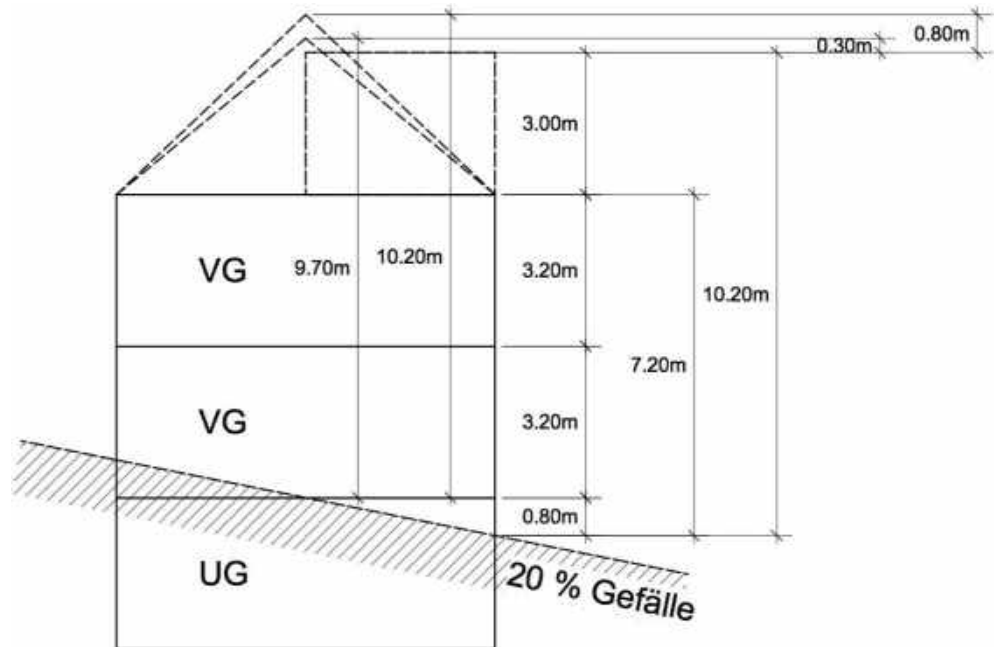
Vergleichsskizze Gebäude mit Schrägdach und Flachdachbau mit Attikageschoss am Hang (Quelle: PLANAR, 2018)
